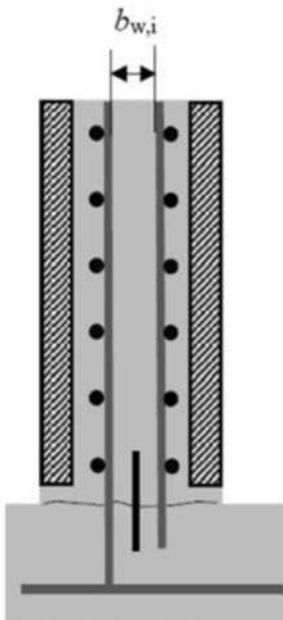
Typische Einbausituation von WU-Elementwänden mit innenliegender Fugenabdichtung, vertikaler Anschlussbewehrung und horizontaler Verteilerbewehrung (beidseitig) [4]
